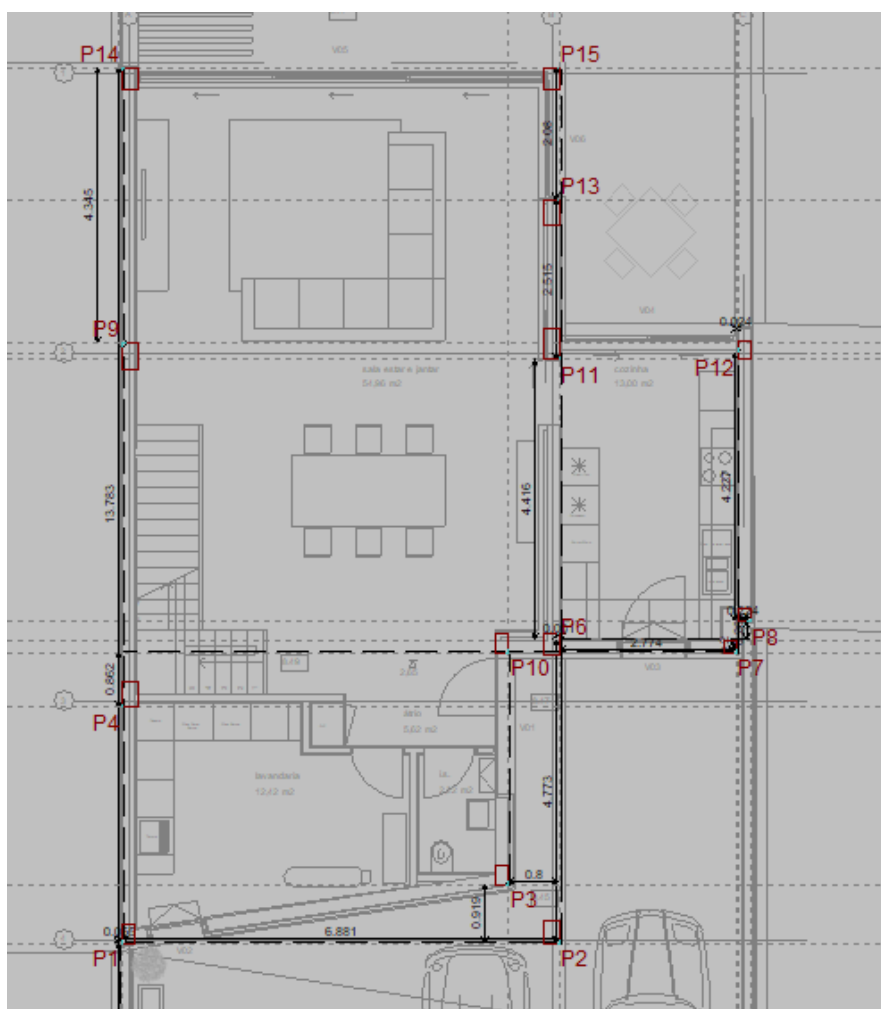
Planta Estrutural (Fonte: CYPE)
